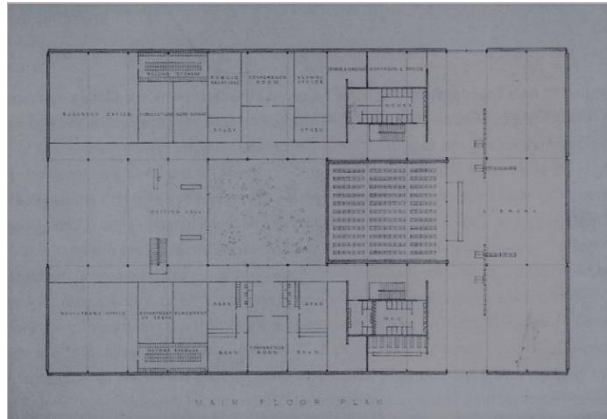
PLANTA BAJA ITT BUILDING FUENTE: [HTTP://INTRANET.POGMACVA.COM](http://intranet.pogmacva.com)
